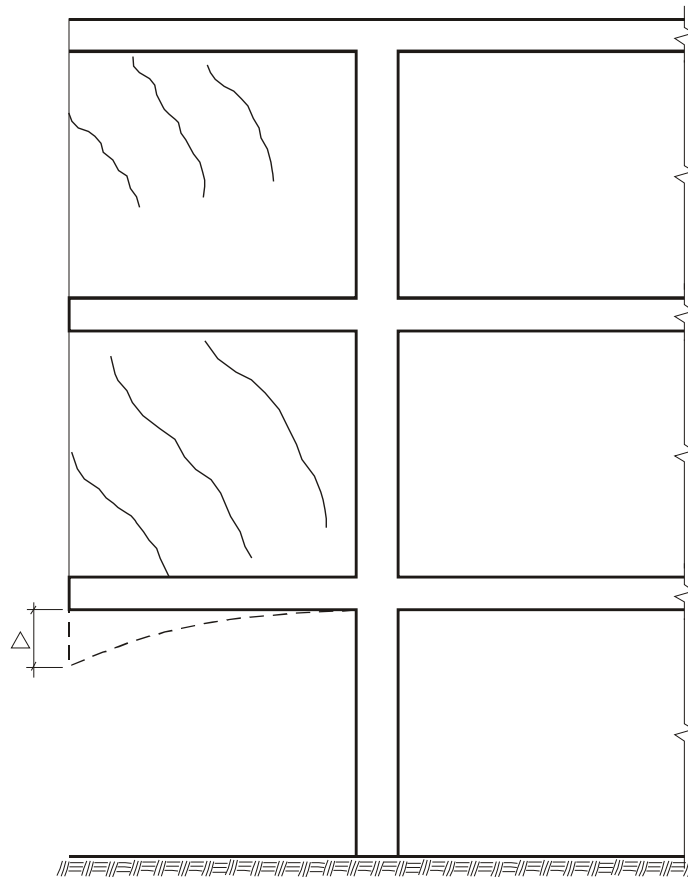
Fissuras inclinadas nas alvenarias provocadas pela flexão de vigas em balanço.
